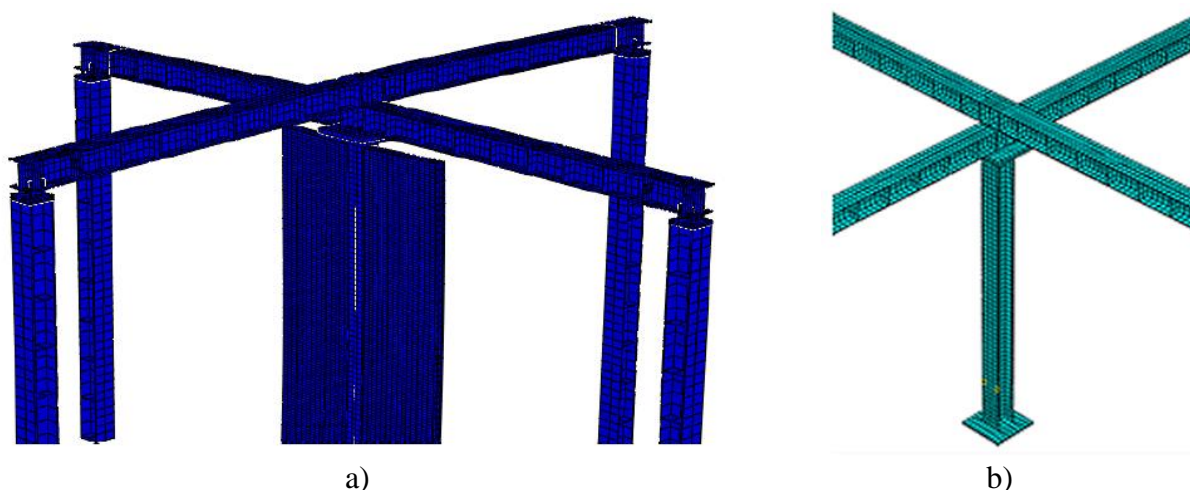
Modelo tridimensional e malha de elementos finitos do pórtico de restrição e pilar a) pilar de aço em contacto com as paredes b) pilar de aço isolado, (Correia et al. 2010b)
